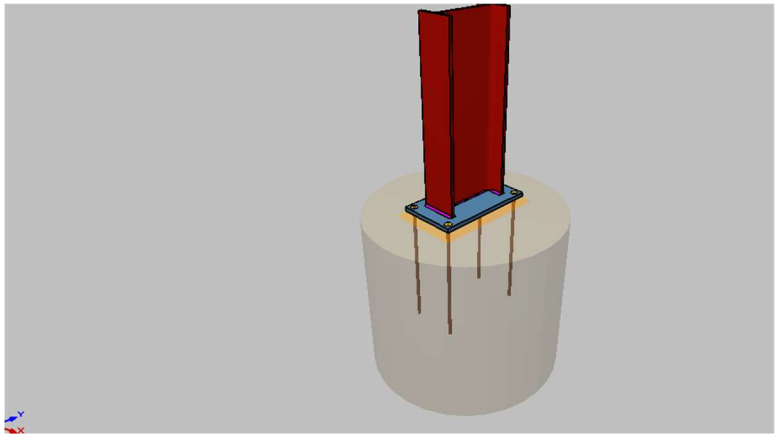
UNIÓN ZAPATA. FUENTE : CYPE 3D
